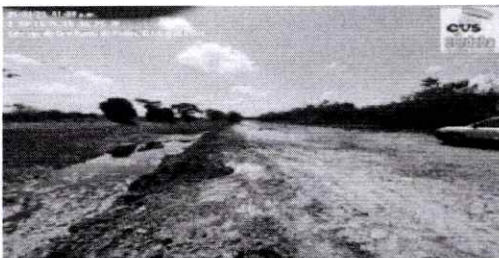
Sitio de presunta extracción de material de relleno utilizado
